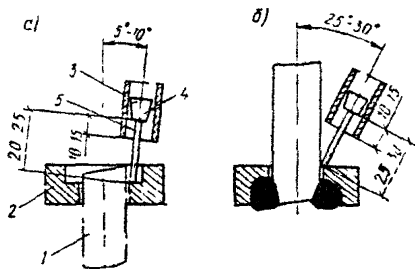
Схема сварки основным (а) и подварочным (б) швами в тавровом соединении стержней диаметром 18-25 мм
